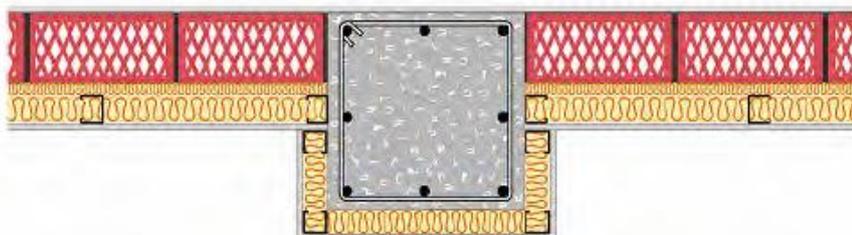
Detalle constructivo de la intersección de pilares en fachada. Fuente: IDAE.
